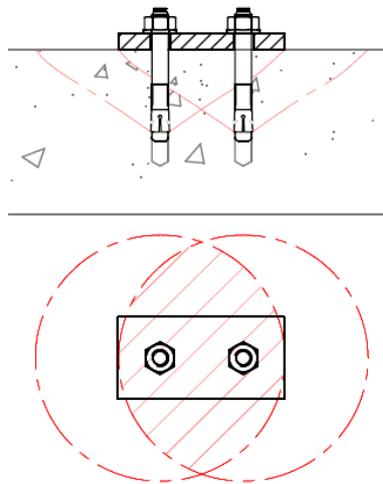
Zones d'influence d'un groupement de chevilles rapprochées en pleine dalle
